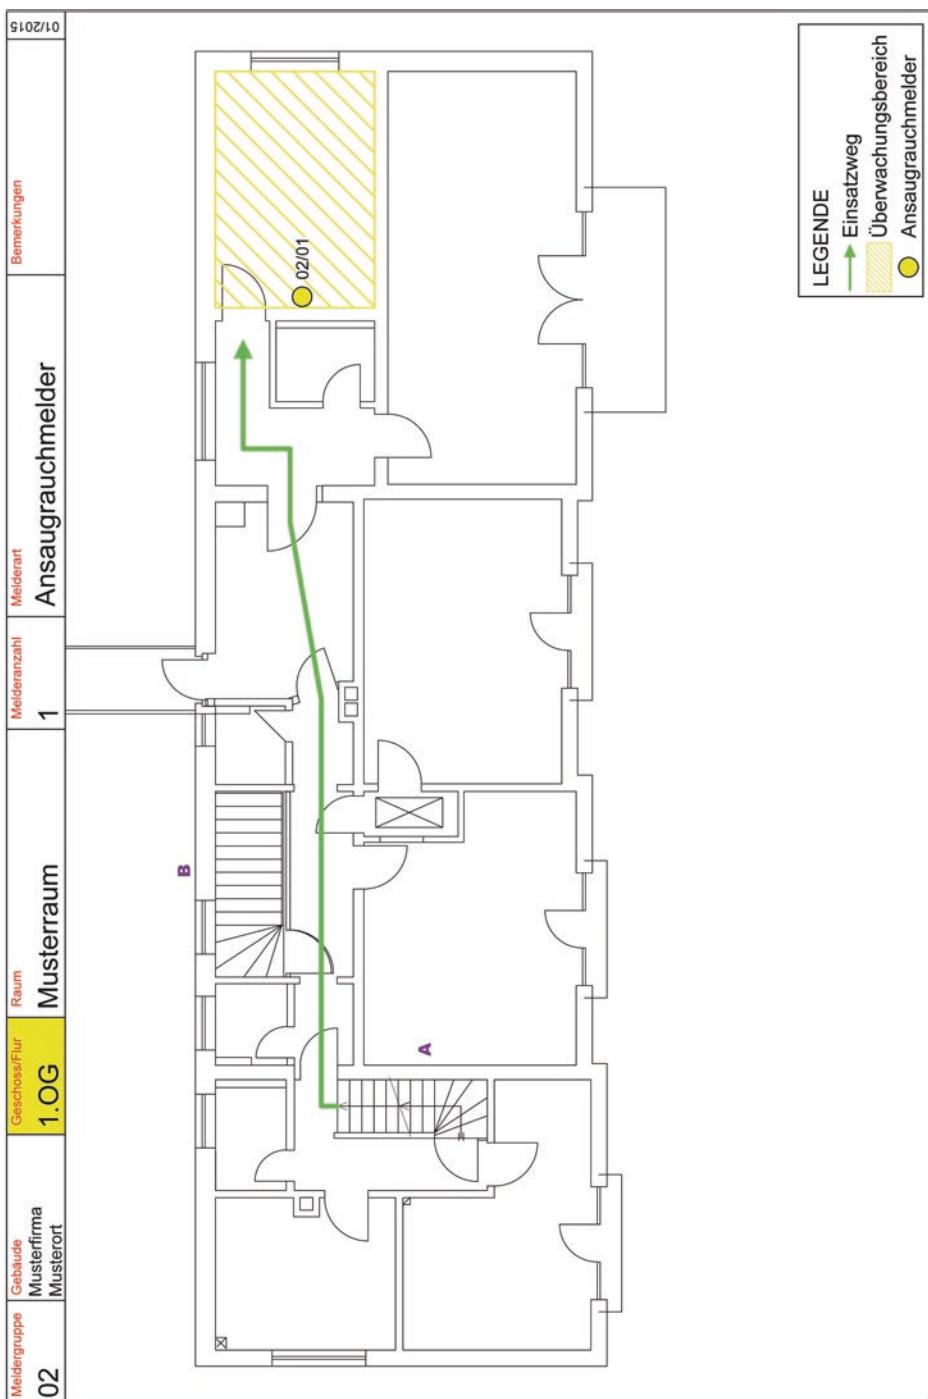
Gebäudegrundrissübersicht. (Volk Zeichenbüro, 77656 Offenburg)
